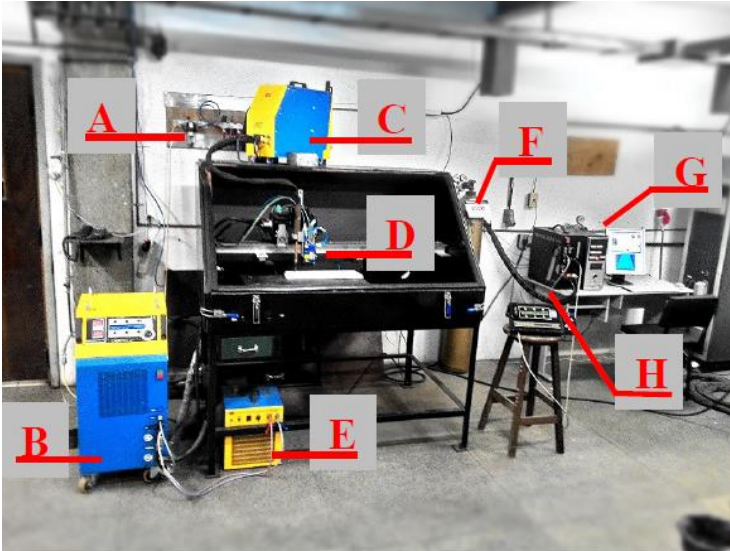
Bancada de ensaios: (A) Filtros, (B) Fonte de soldagem, (C) Cabeçote alimentador, (D) Robô, tocha, sensor óptico e peça, (E) Trocador de calor, (F) Cilindro de gás, (G) Computador e (H) Controlador do robô e IHM, Viviani [9].
